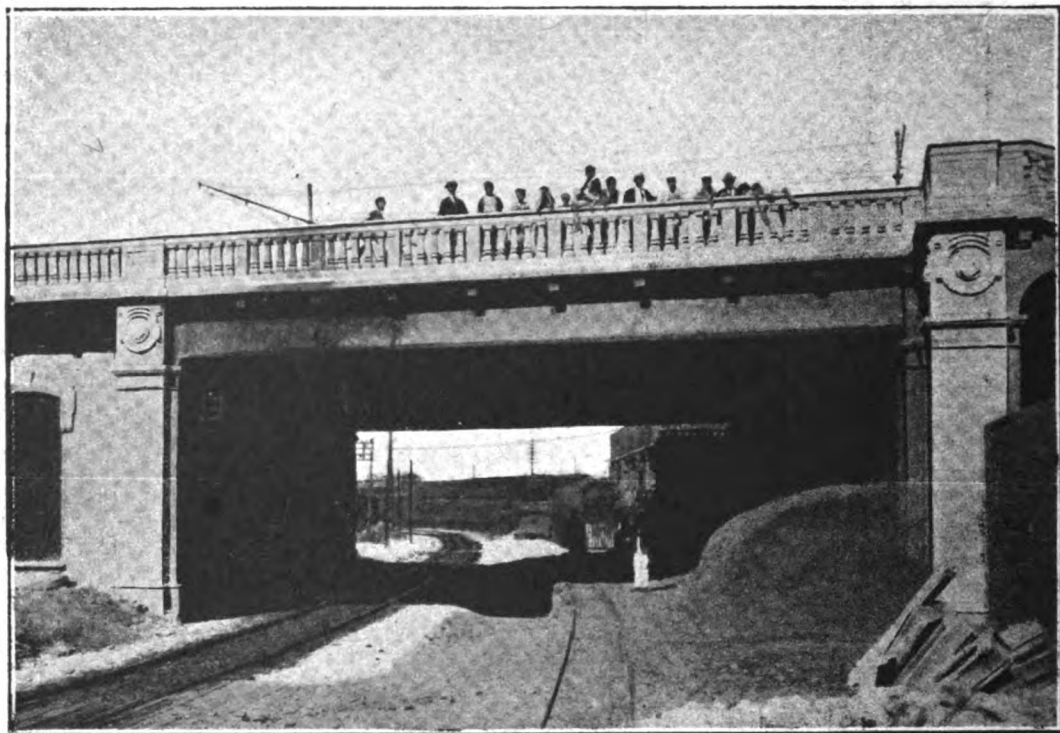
Cavalcavia presso la stazione di Ancona — Impalcatura di cemento armato sulla ferrovia.
